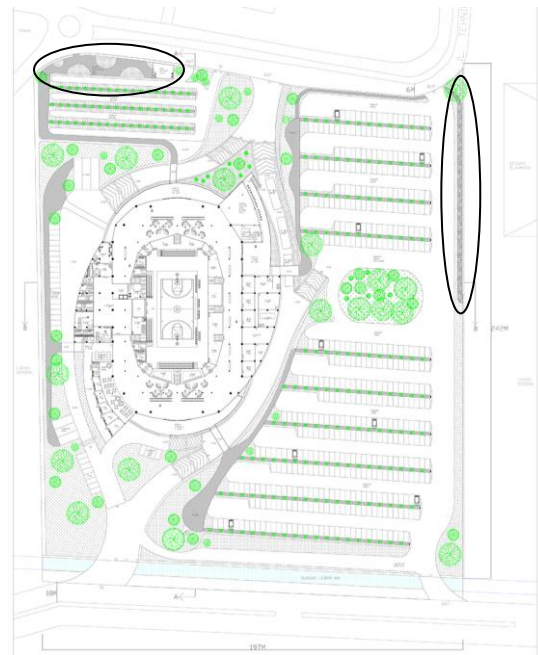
Denah lantai 2. Sumber: penulis
